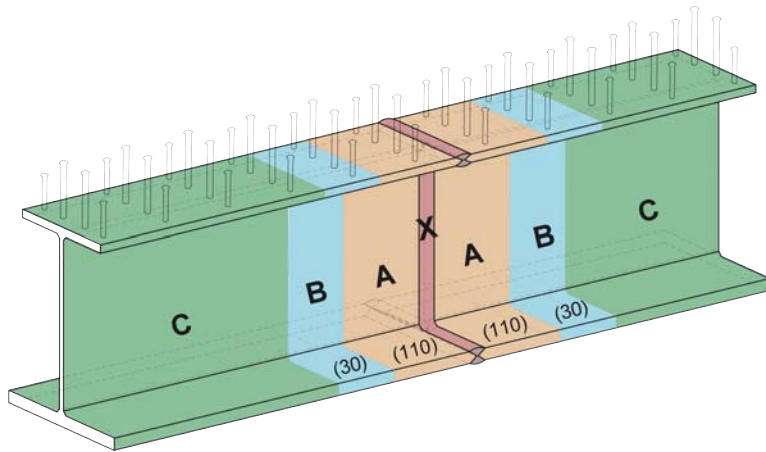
Details zu möglichen Ausführungsformen der Schweißnähte für Stumpfstoße
